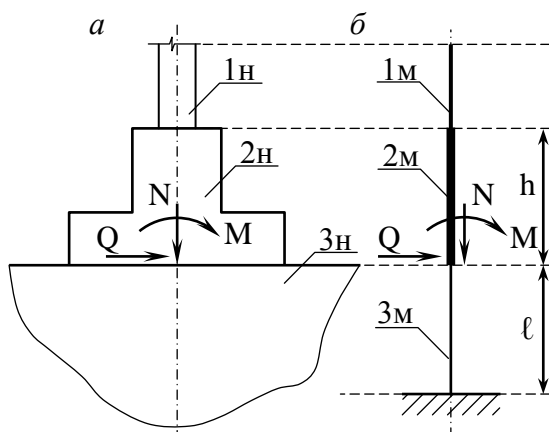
Стрижнева модель ґрунтової основи: a – натурна конструкція; b – стрижнева модель; 1н – колона; 2н – фундамент; 3н – ґрунтова основа; 1м – стрижнева модель колони; 2м – стрижнева модель фундаменту; 3м – стрижнева модель ґрунтової основи
